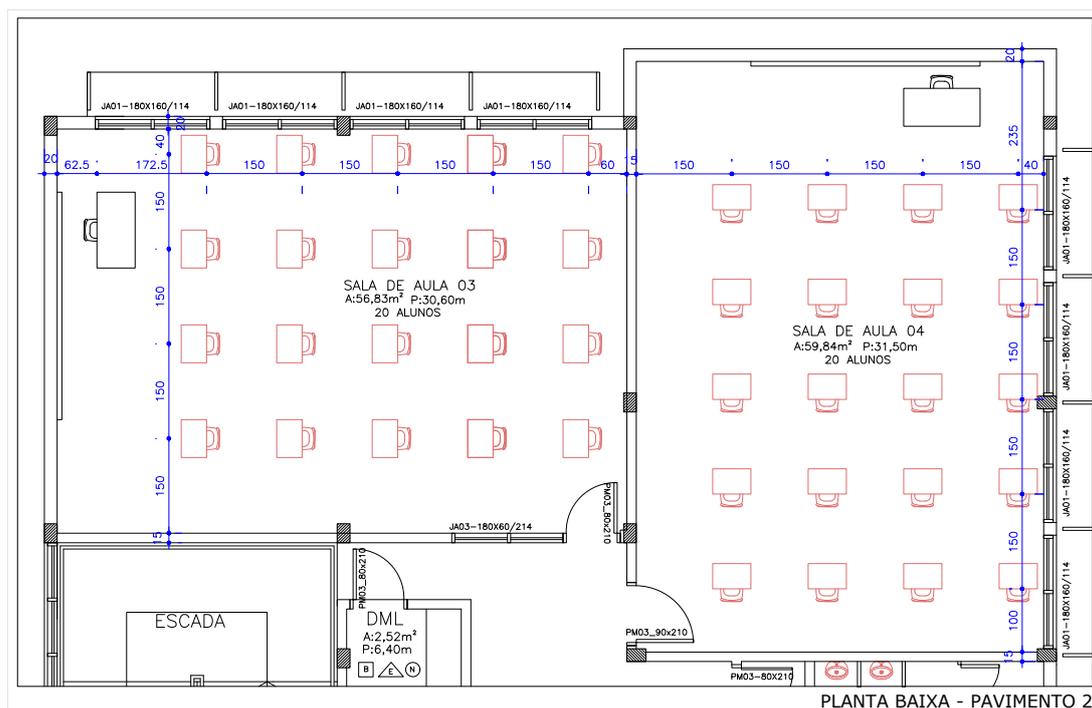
b: Planta baixa primeiro pavimento com distribuição das classes e cadeiras mantendo o distanciamento de 1,5m.
